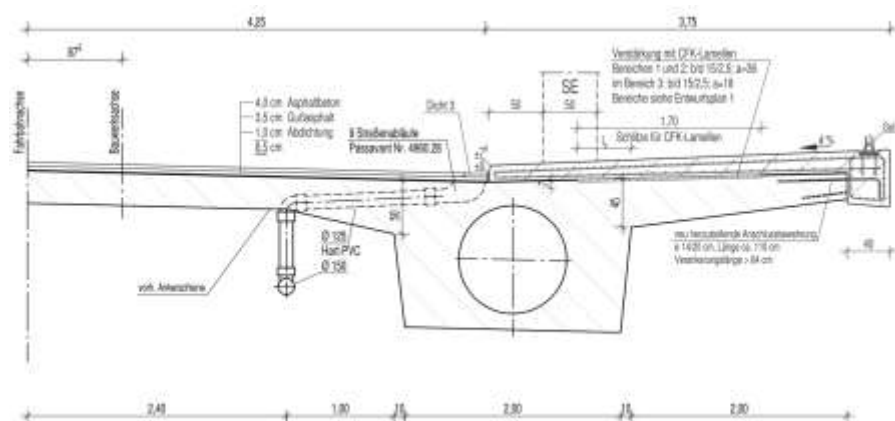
Detail „Kragarmanschnitt“ mit CFK-Lamellen
